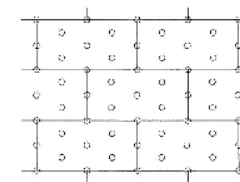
DETAIL PROVÁDĚNÍ ZATEPLENÍ
